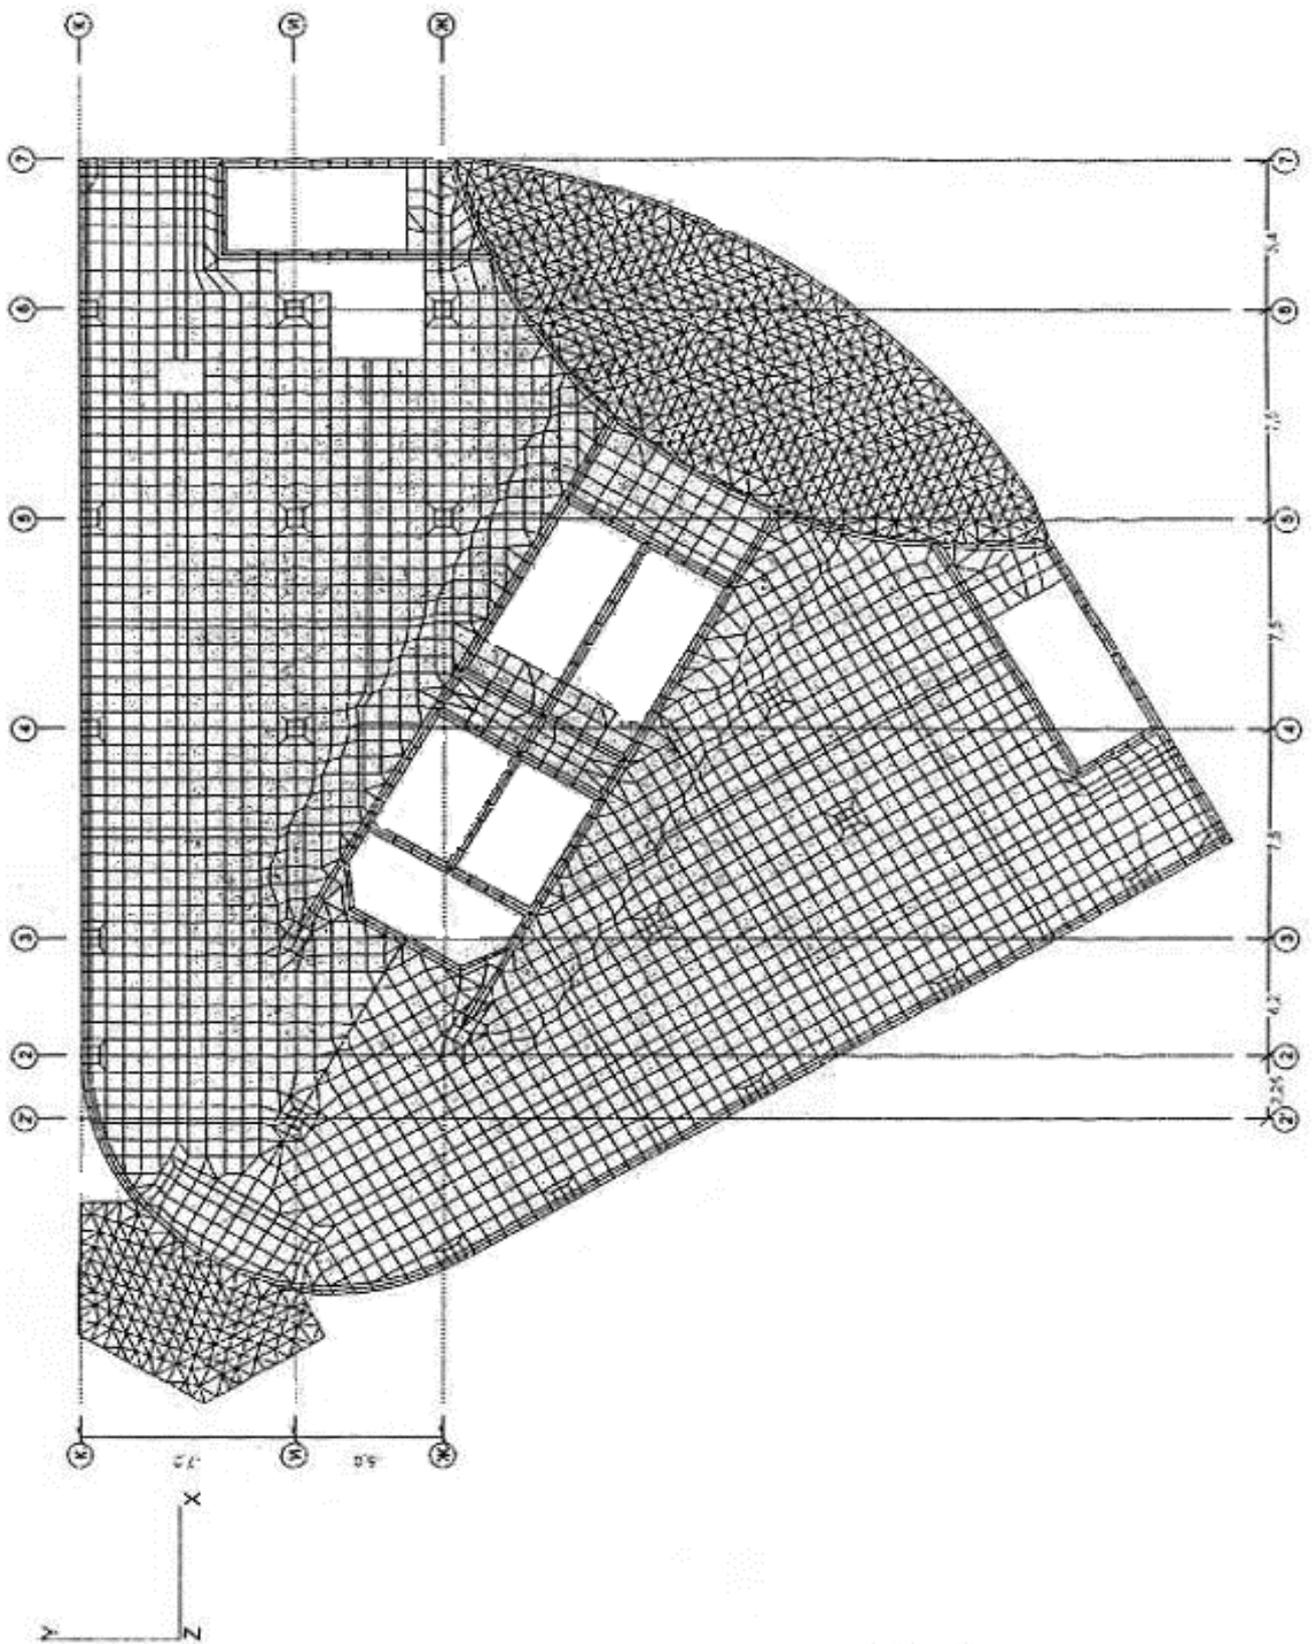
Расчетная схема с разбиением на конечные элементы плана второго этажа на отметке +4,500 м к расчету железобетонного каркаса 14-этажного каркасного здания на предотвращение прогрессирующего обрушения
